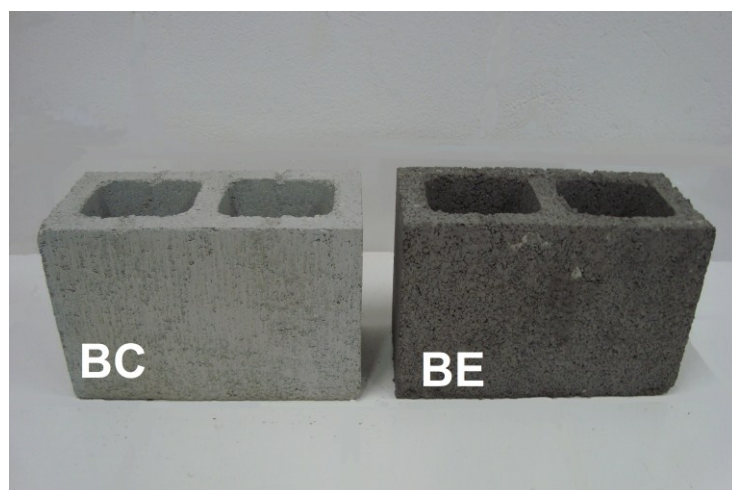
Bloco de concreto para alvenaria estrutural e bloco de escoria de aciaria
